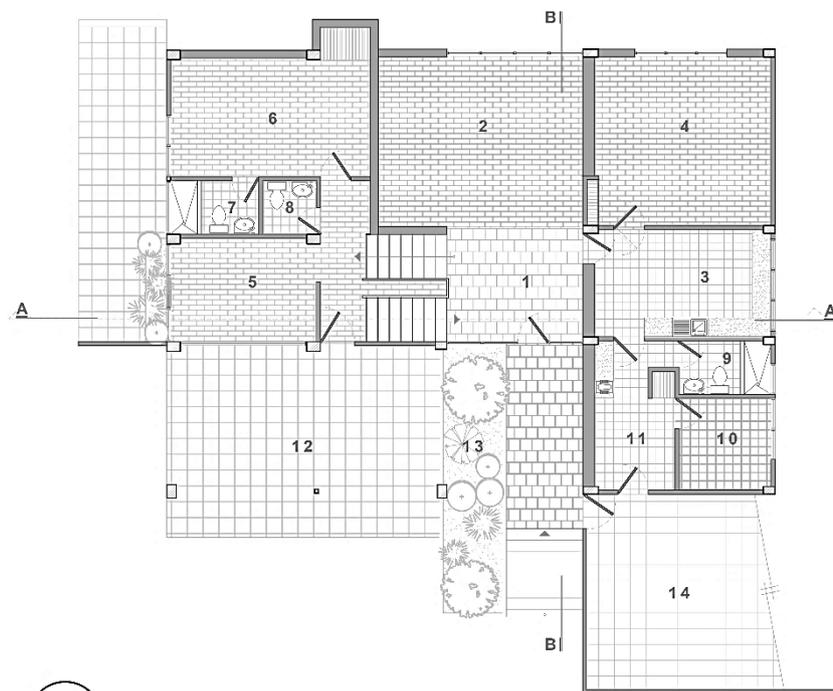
Zonificación en Planta Principal en Casa Moncayo.
